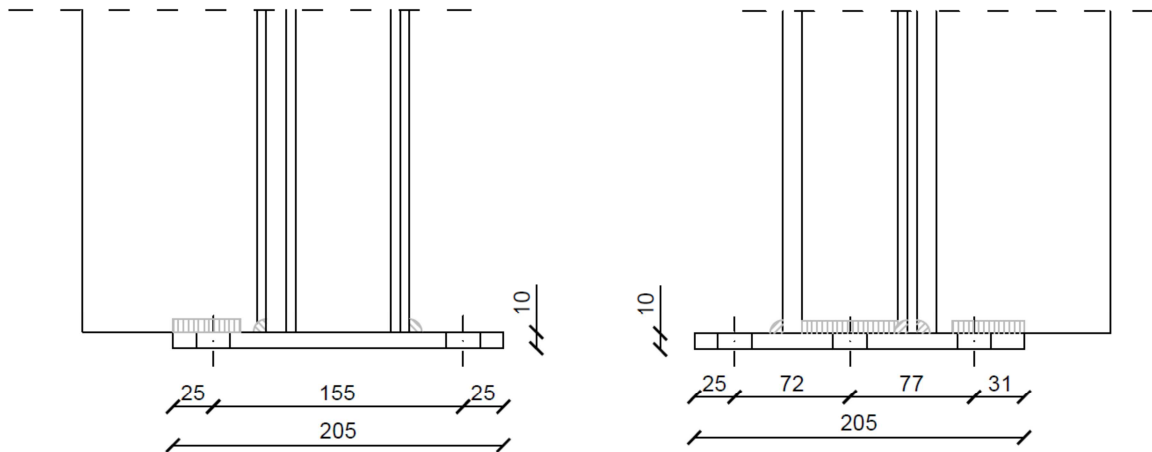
Sezioni A-A e B-B del collegamento di continuità dei montanti ad L
